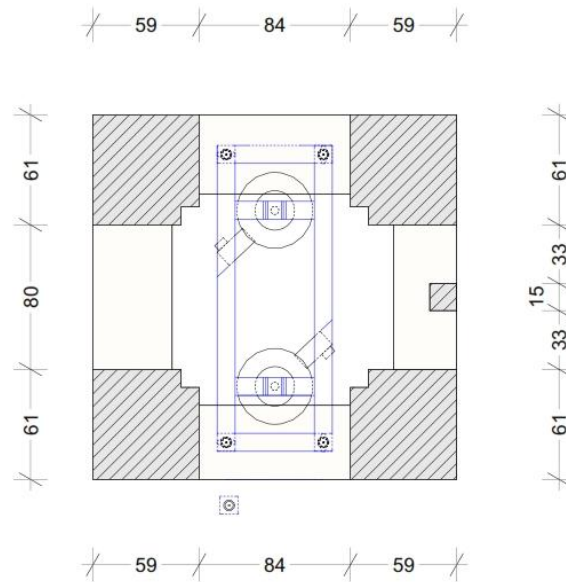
Pianta del campanile e superfici di appoggio della nuova struttura campanaria.
